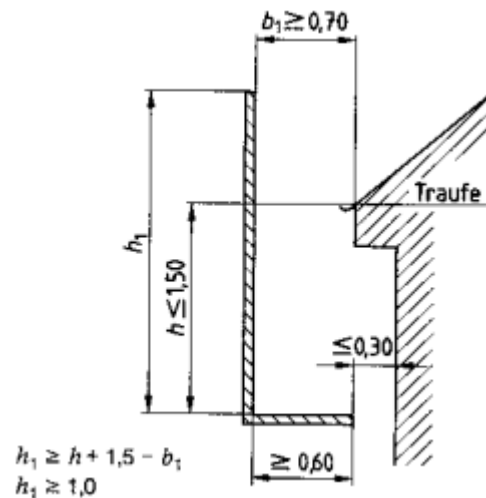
Bauliche Durchbildung der Dachfanggerüste
